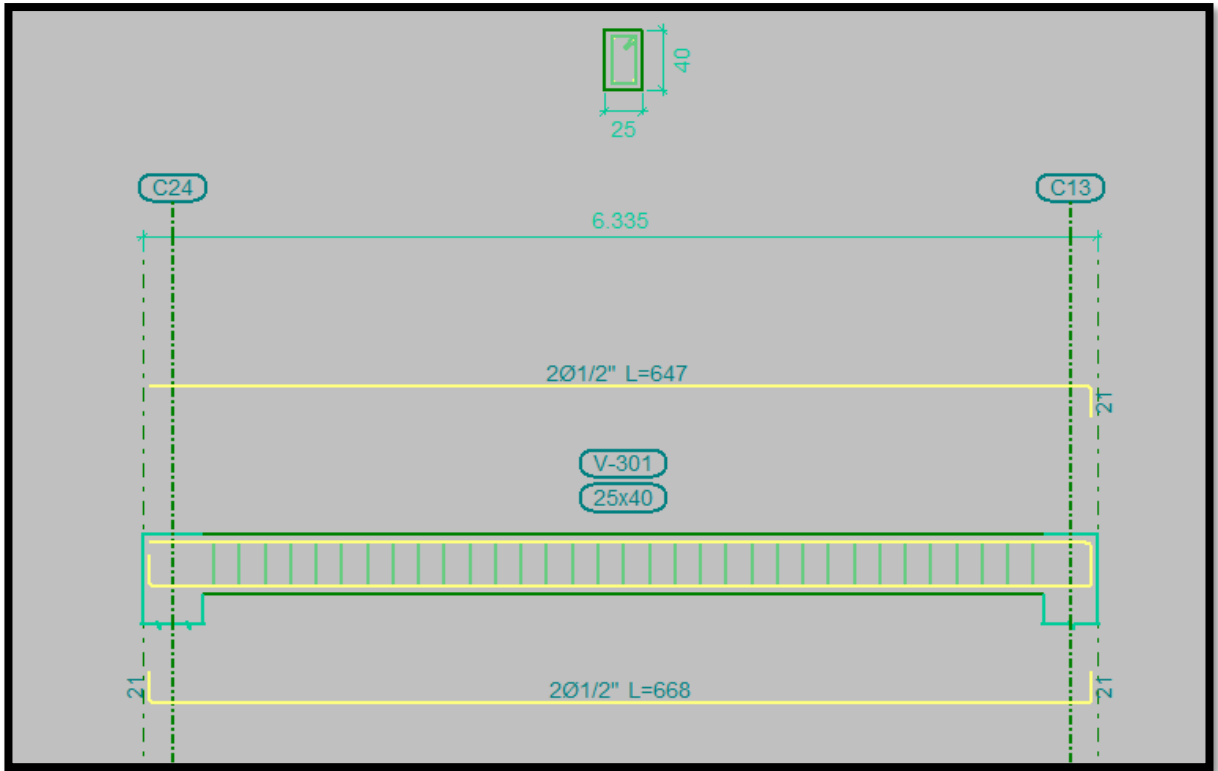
Detalle de vigas secundarias módulo 1 y 2.
